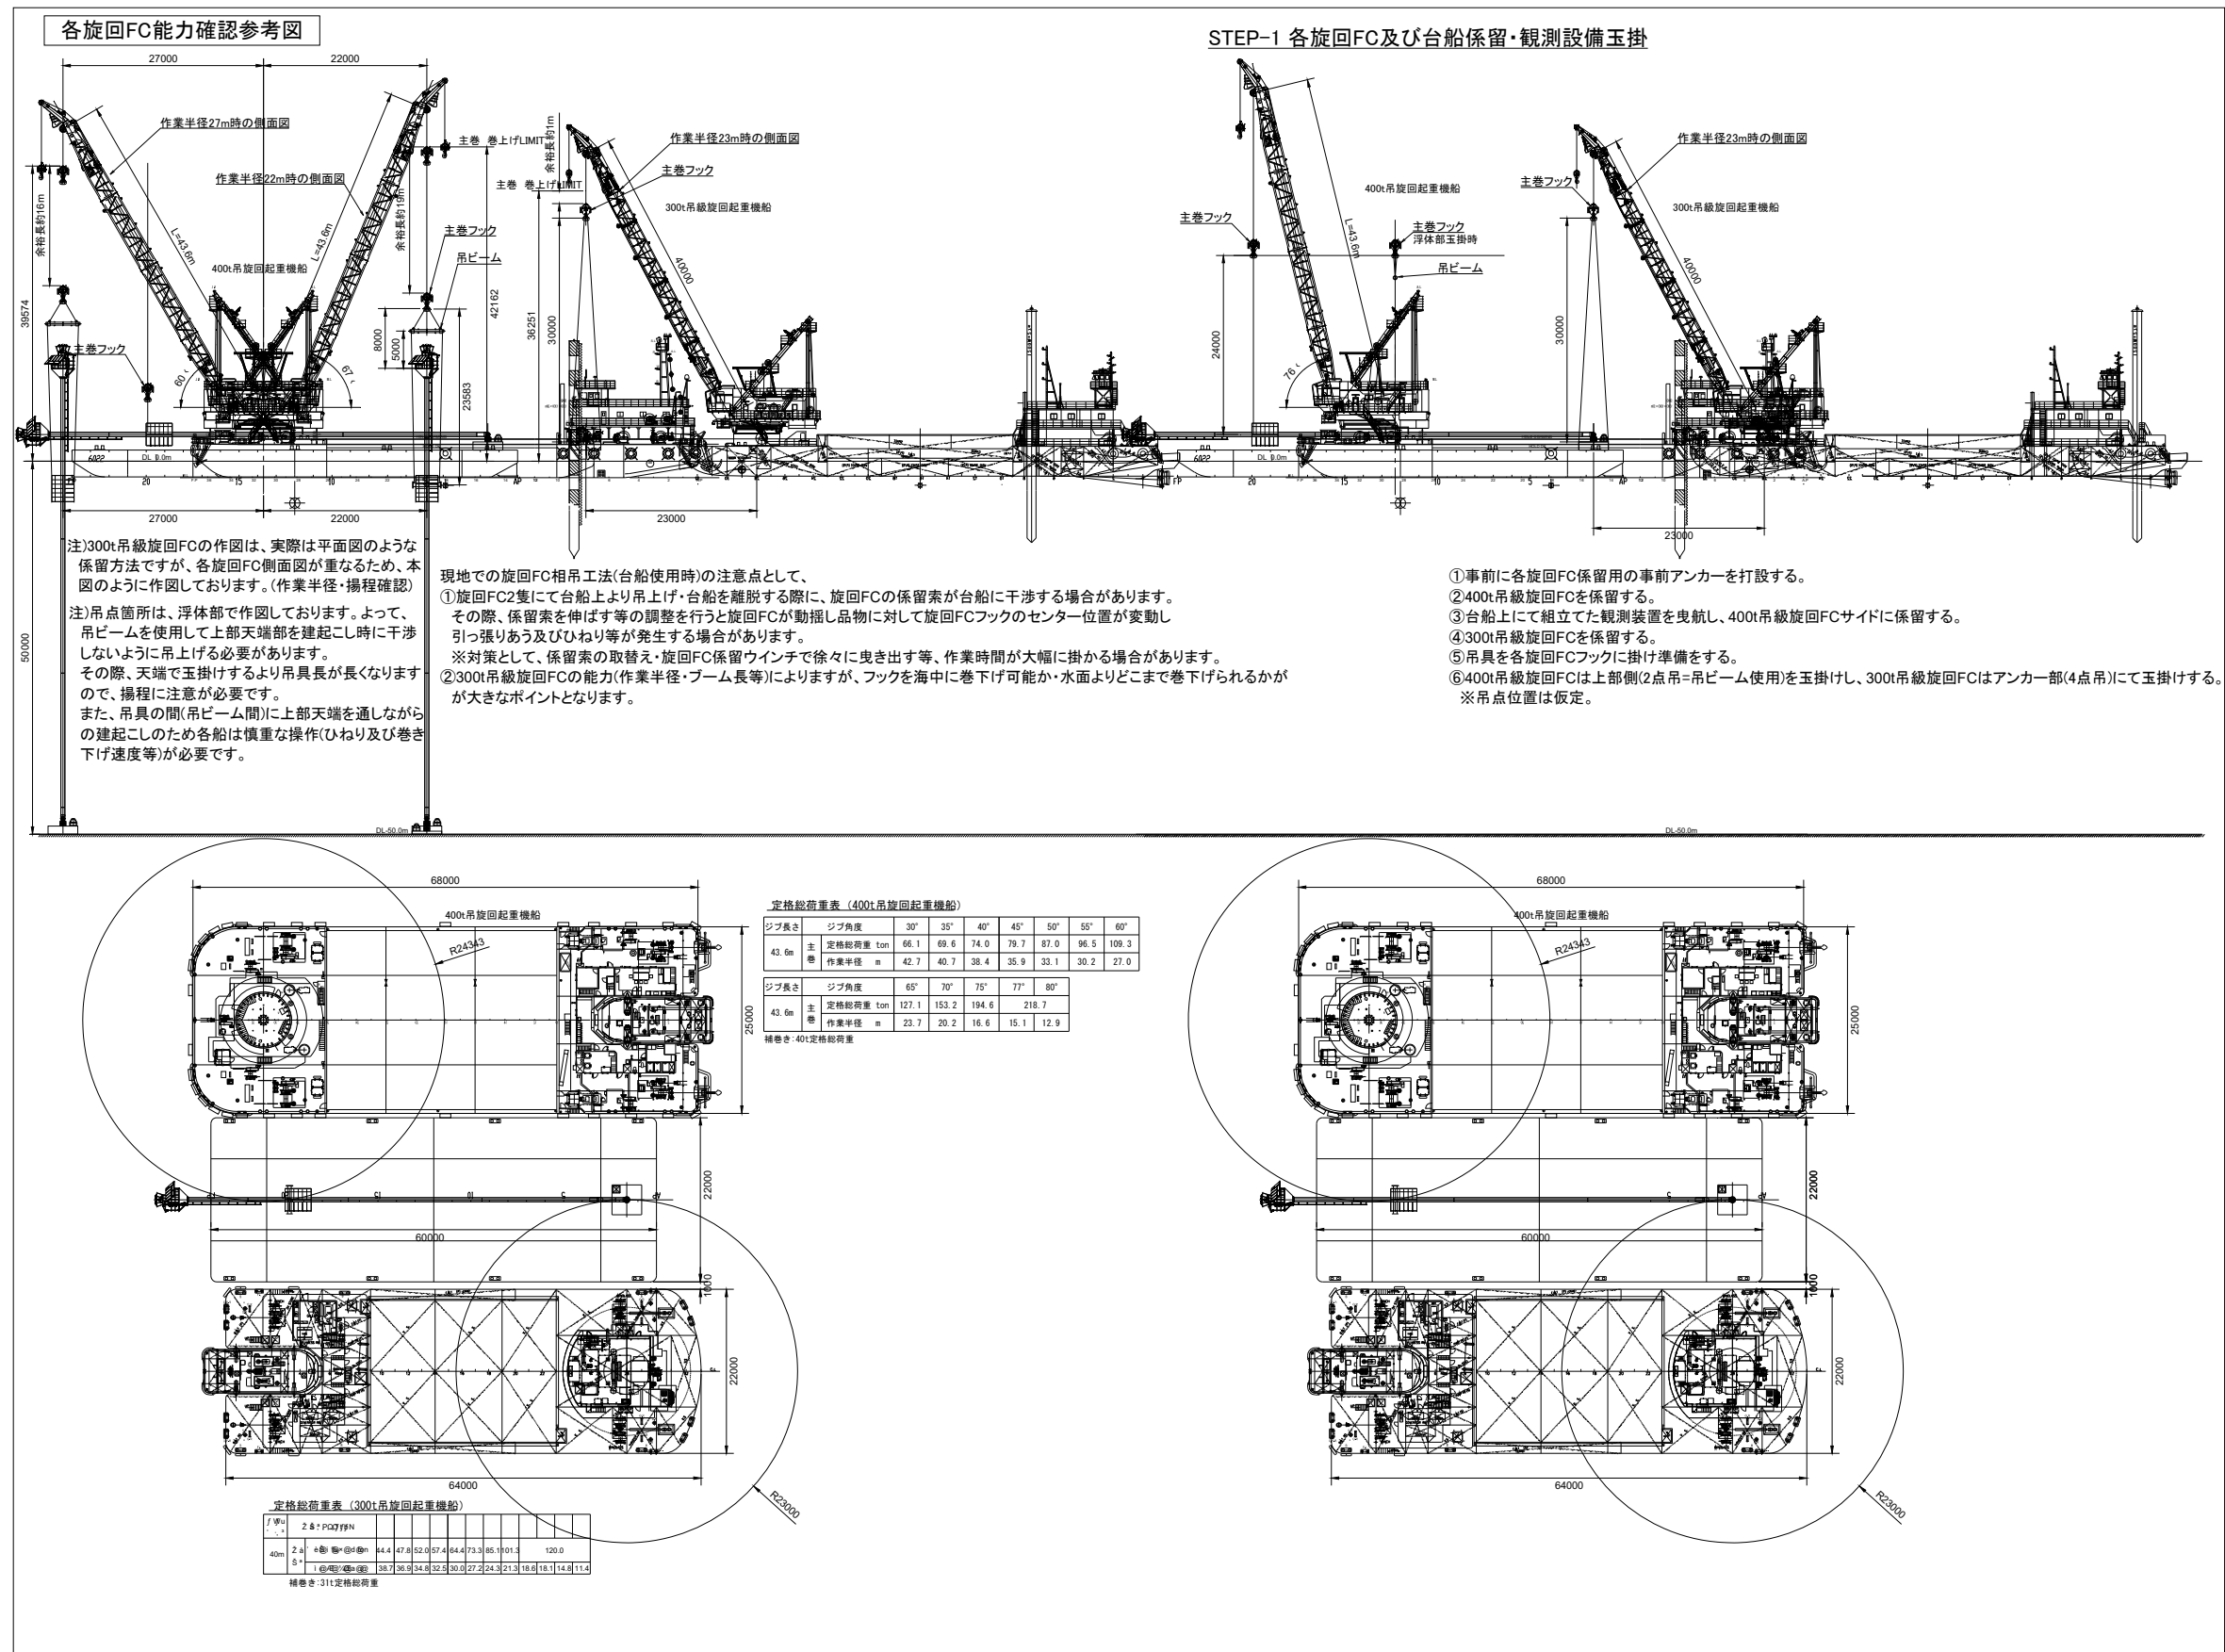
2.1 CASE-2 施工ステップ図 (その 1)
